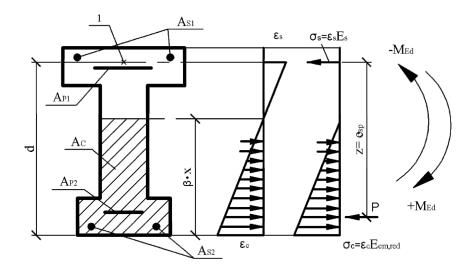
Схемы усилий и напряженно-деформированного состояния сечения с трещиной в стадии изготовления
